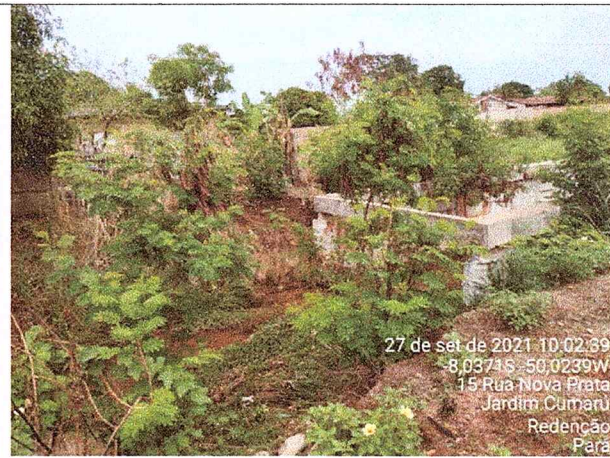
Início da Etapa I- Calha já concluída do Canal em placas de concreto pre moldado
